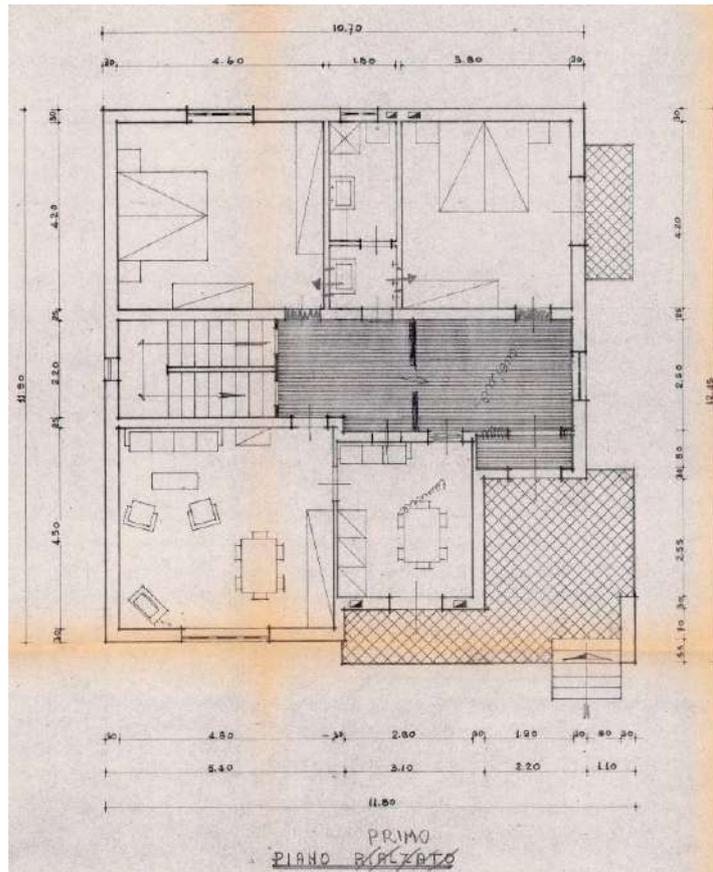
Licenza di Costruzione n. 1289 del 04.03.1968 - pianta piano rialzato (erroneamente corretto piano primo)
